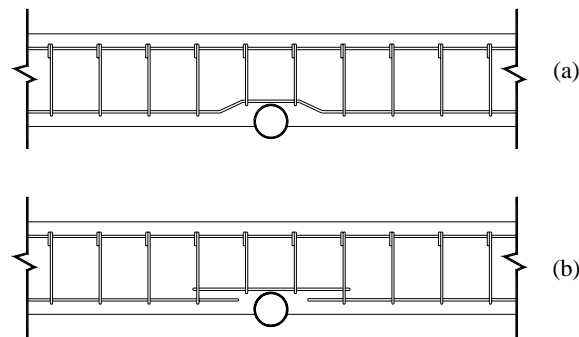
Mala disposición del refuerzo longitudinal en vigas por la presencia de tuberías transversales.
